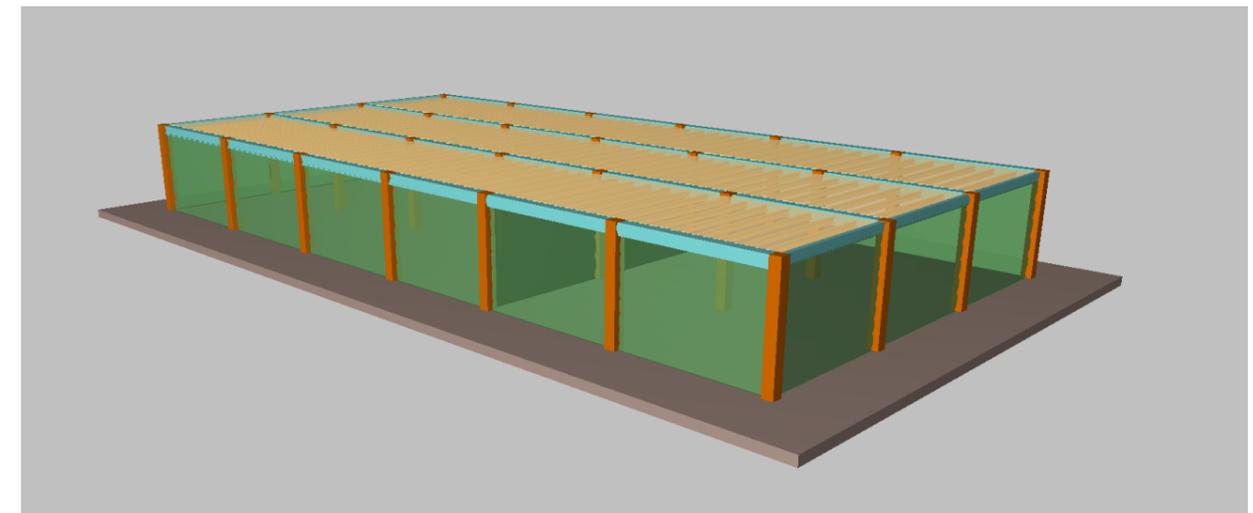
Estructura 3D vista 1 (Fuente: CYPE)
